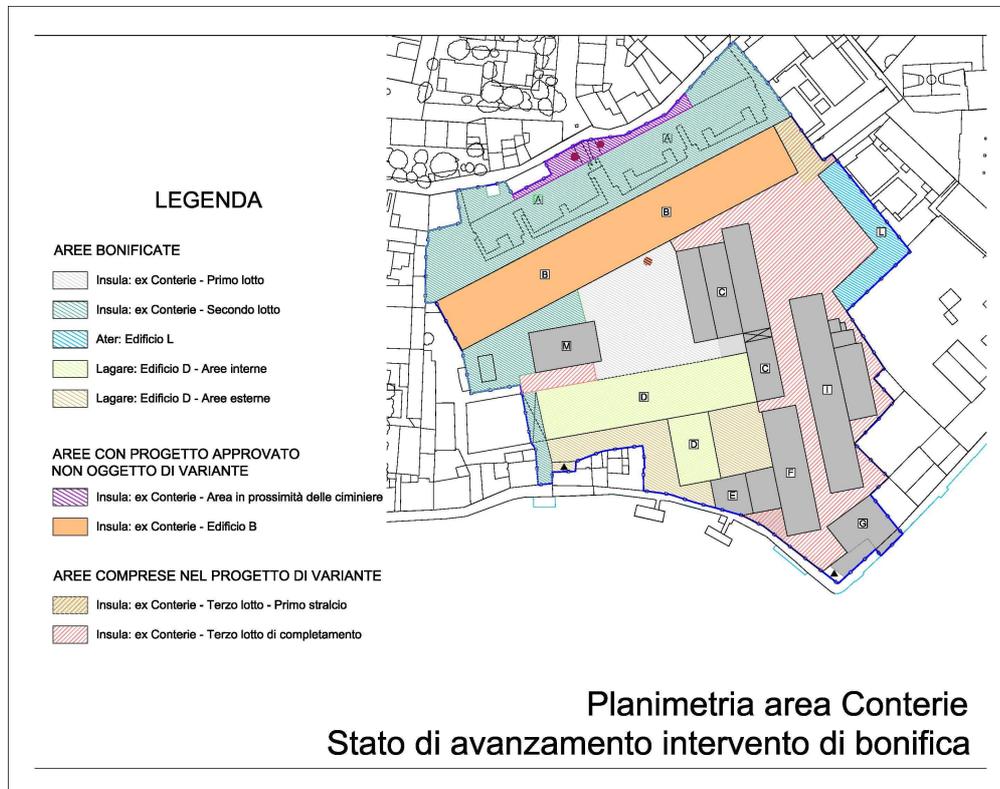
Area ex Conterie: suddivisione in lotti d'intervento e in aree di proprietà
